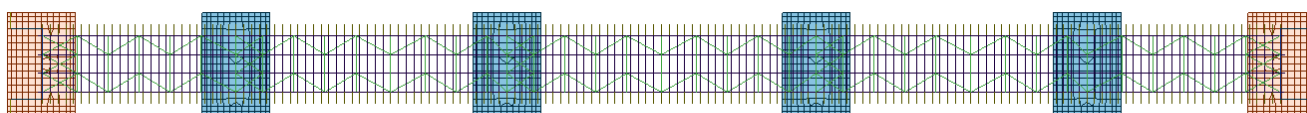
Modellazione tridimensionale Elementi finiti – pianta
